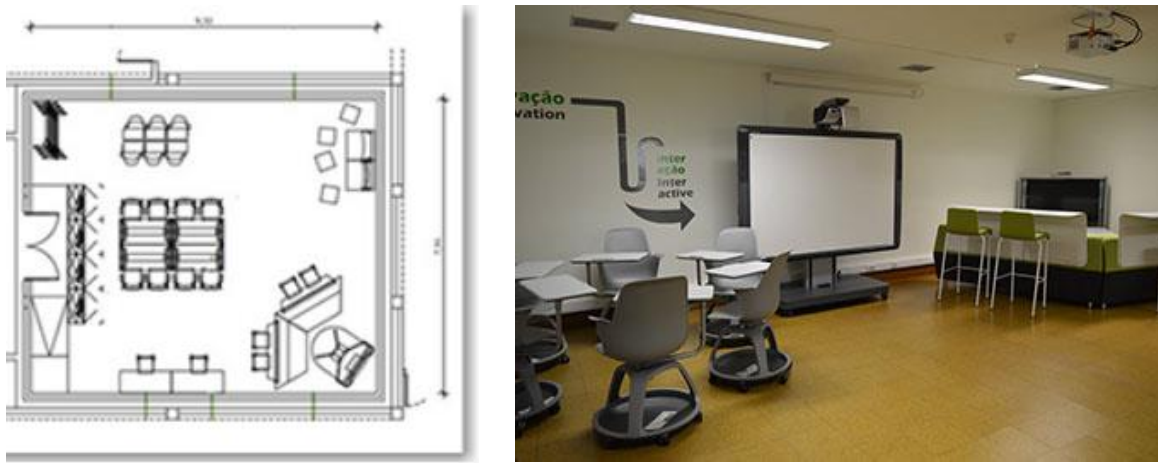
Planta baixa e Vista real do *Future Teacher E-ducation Lab
